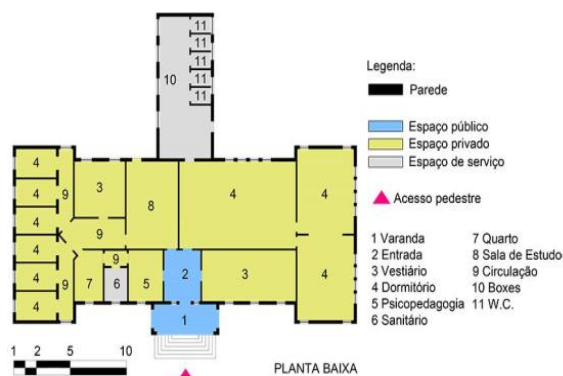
Planta-Baixa da Casa/Pavilhão de Triagem⁵⁰¹
